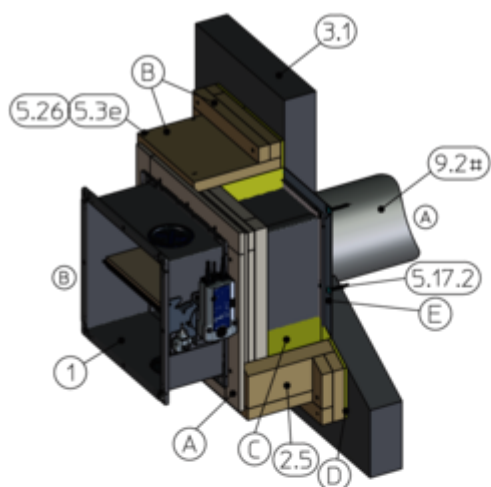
Torr installation utan murbruk på framsidan av en massiv vägg (betongvägg visas) med installationskit WA (väggfäste och inmurad kanal)
